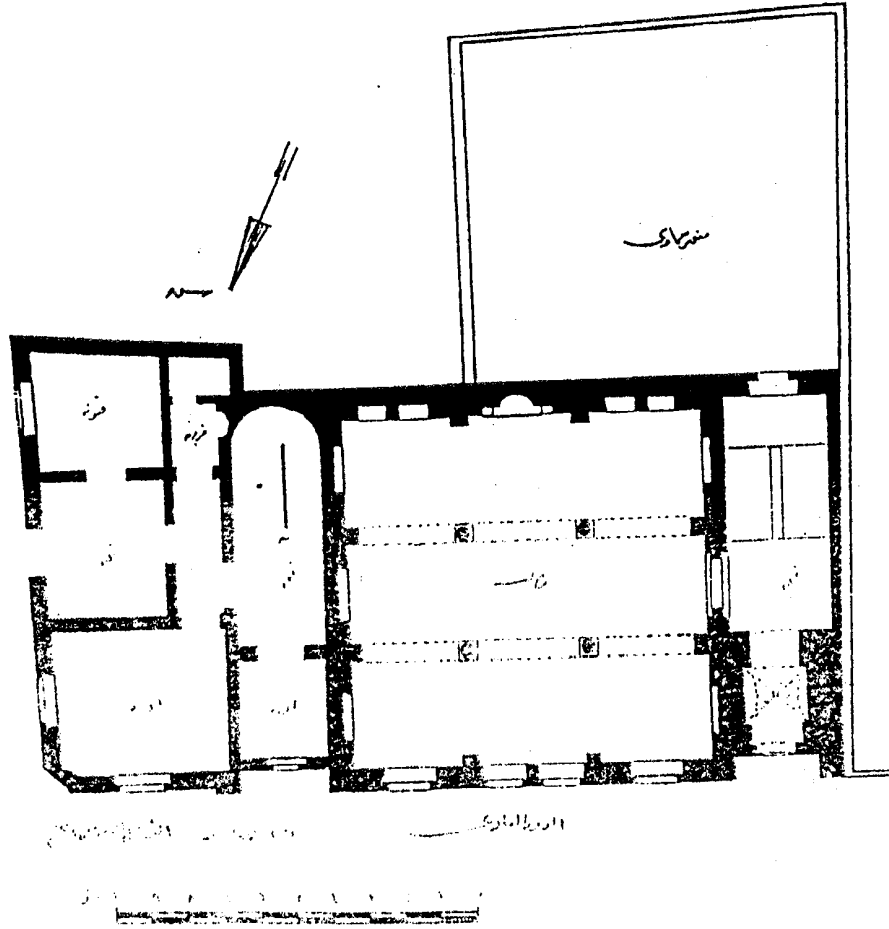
مسقط أفقي لجامع عثمان كتحذا (الكخيا)
